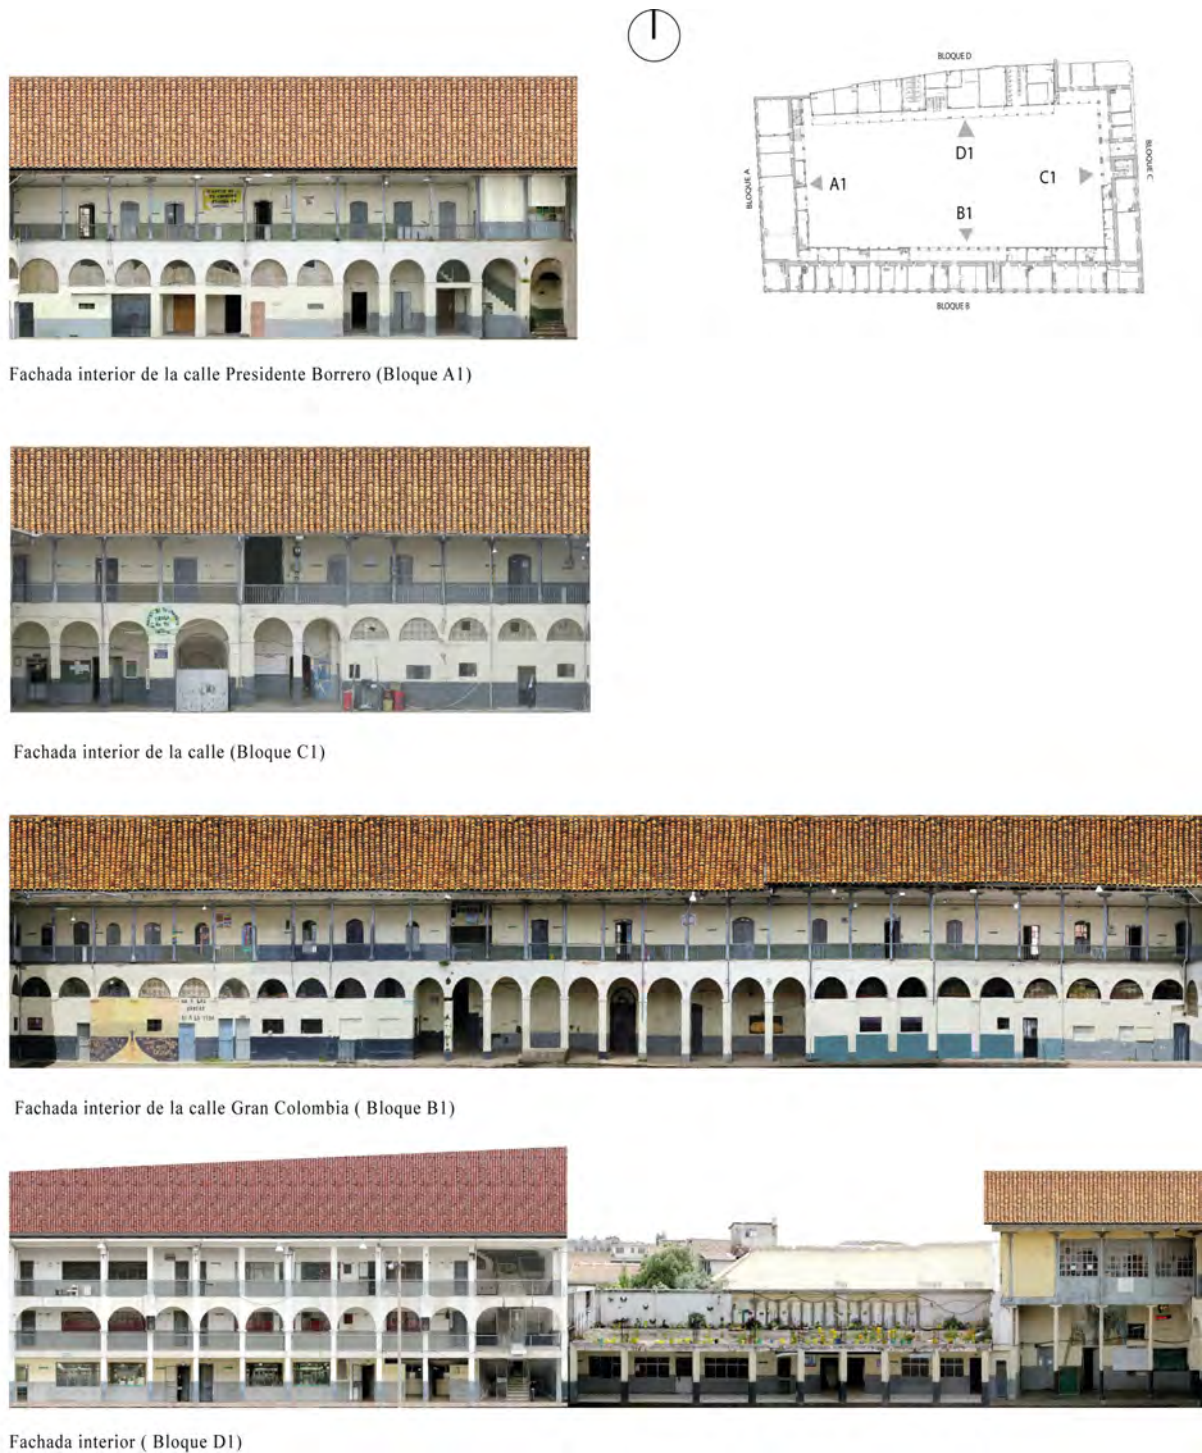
Imágenes del estado actual de las fachadas interiores. Fuente y elaboración: propia.
